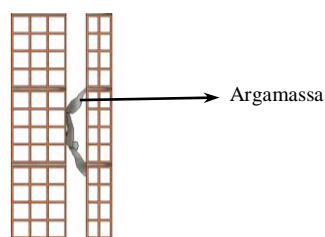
Parede dupla com ligações rígidas entre panos
